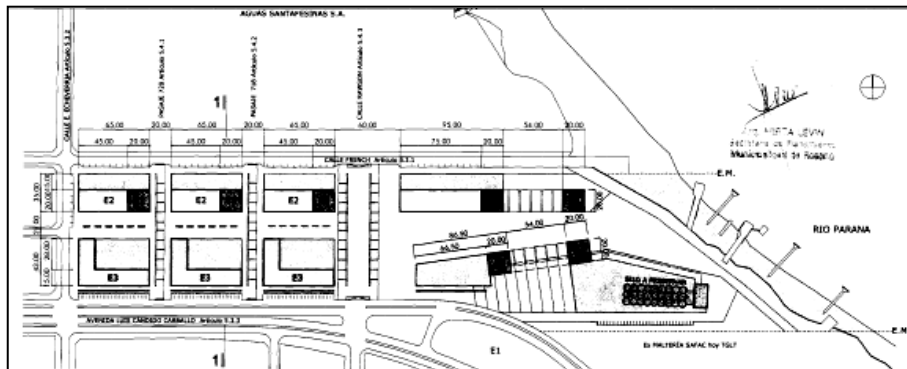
Plan de Detalle- Unidad de Gestión 1
